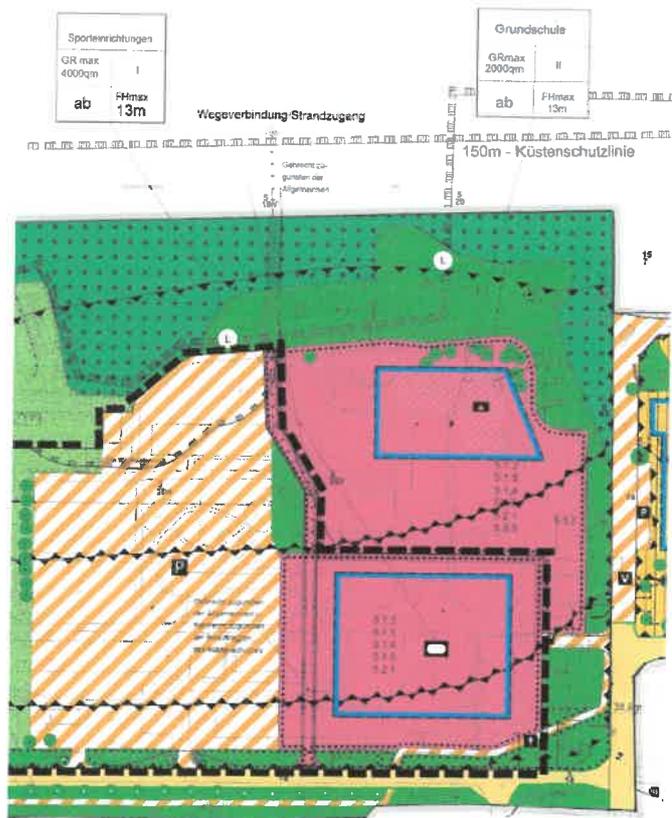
Ursprungsplan (Stand 1. Änderung)
